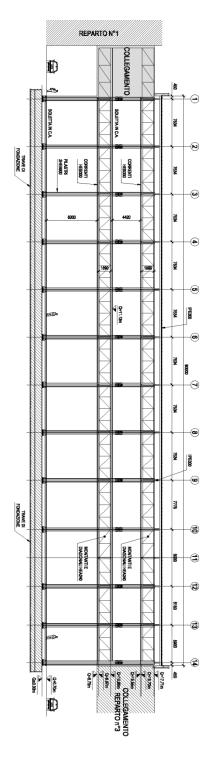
Sezione longitudinale tipo struttura di elevazione
